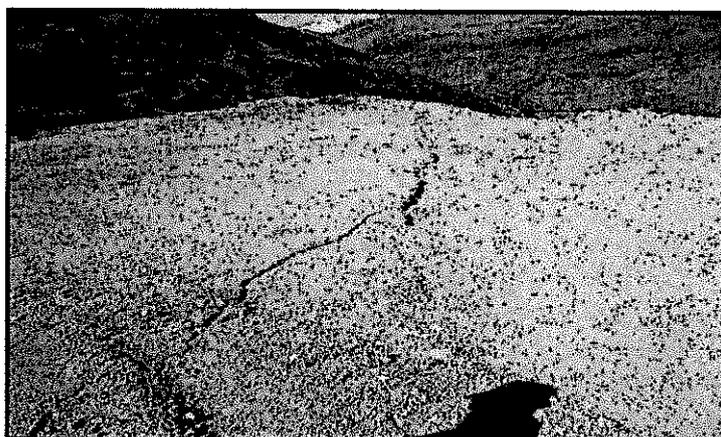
Parte superior del tajo Santa Rosa que presenta grietas o rajaduras bien pronunciadas, que ponen en peligro dicho tajo, situado en la Unidad Minera “Andes 1”.
